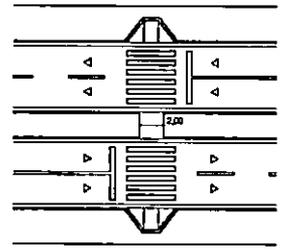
Canteiro divisor de pistas - Exemplo 2
